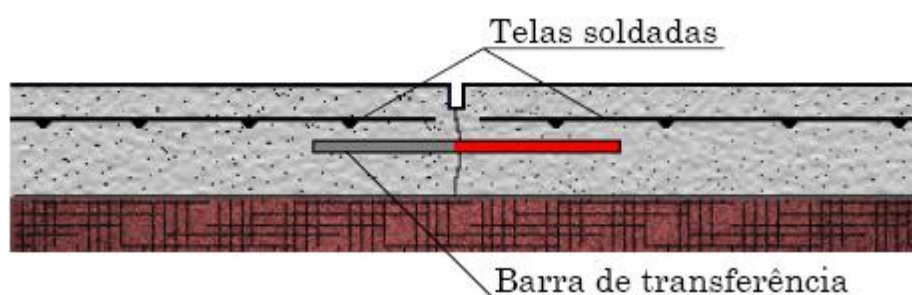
Seção de pavimento de concreto com armadura distribuída descontínua.
